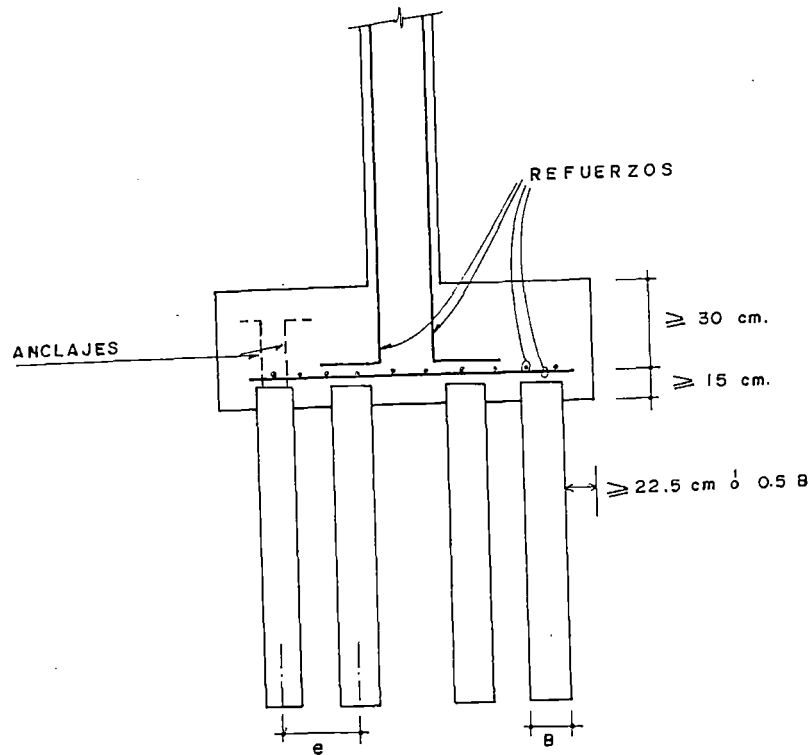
Detalle de anclaje de pilotes en zapatas.
